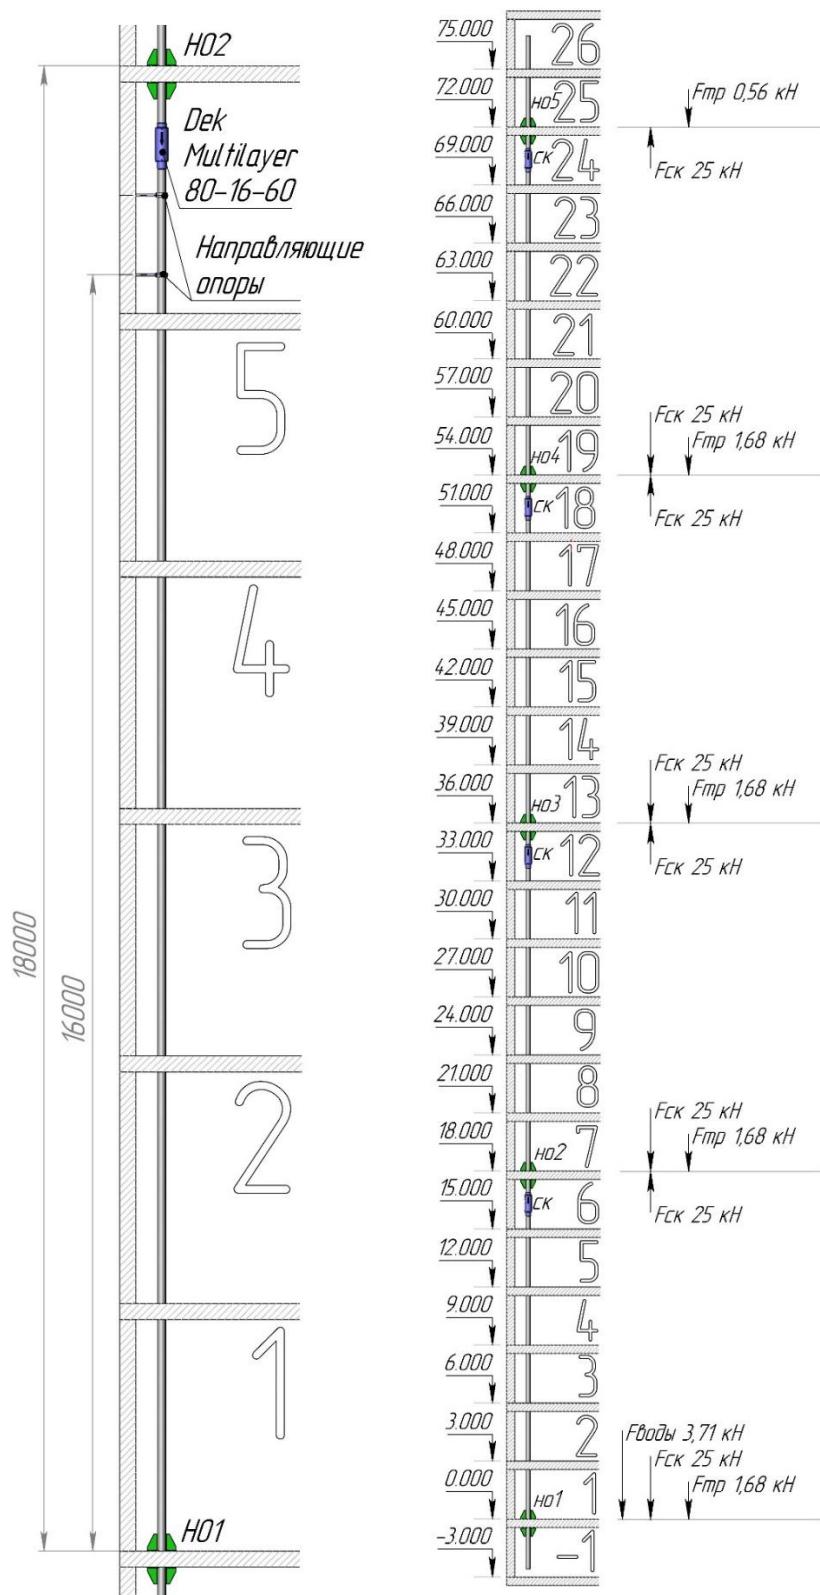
Распределение нагрузок на неподвижные опоры трубопровода ТС Ду80
